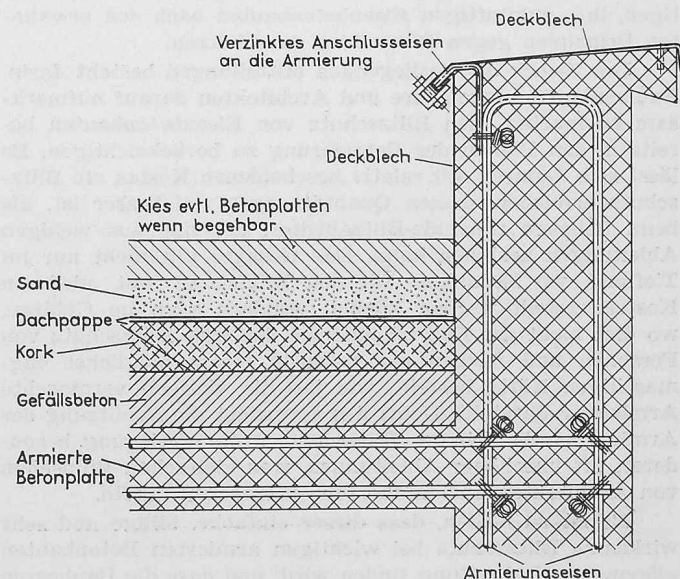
Anschluss der natürlichen und künstlichen Fangleitungen auf einem Flachdach mit Brüstung
